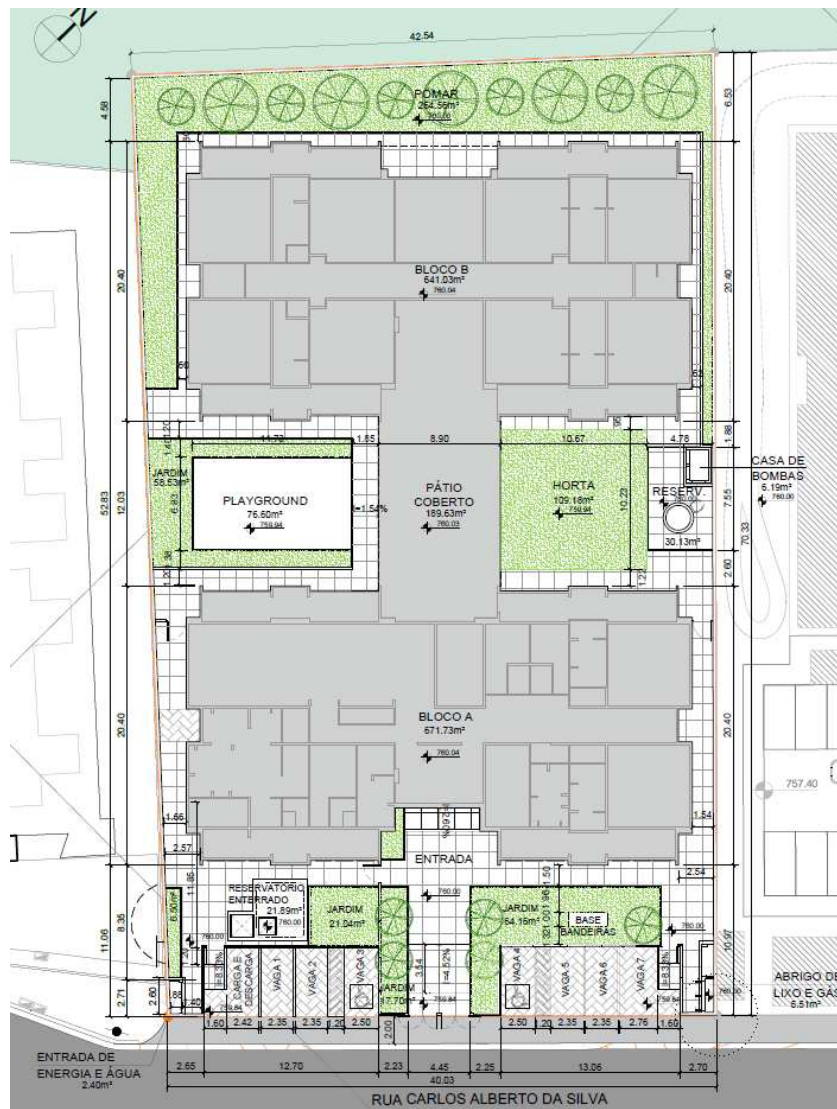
Planta de Arquitetura (DE-MAU01-EDIF-EMO-PE-ARQ-001)
